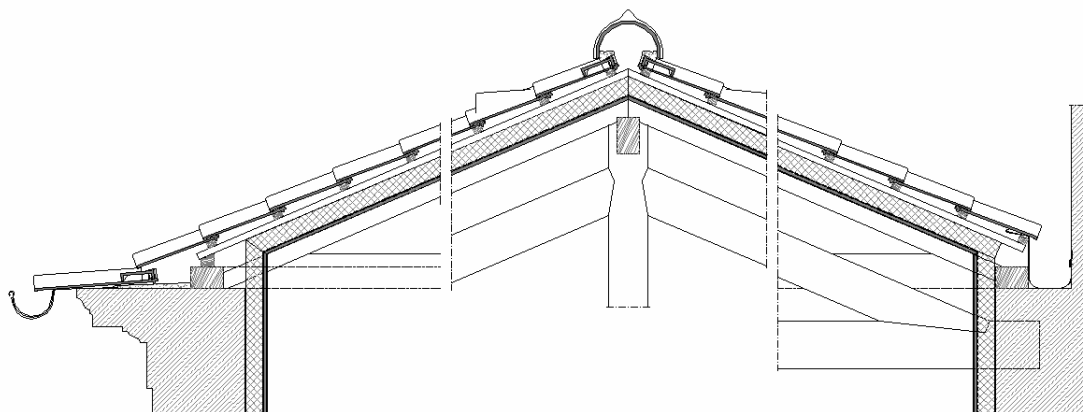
Solução de Isolamento térmico contínuo sobre as varas da estrutura do telhado.
